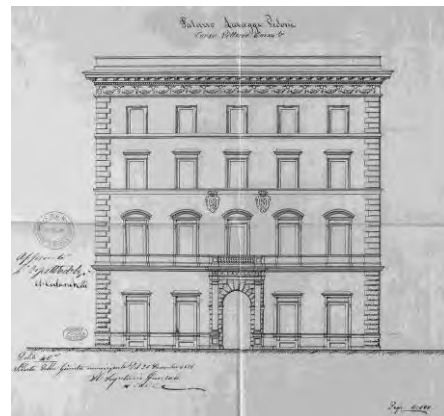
palazzo Lavaggi prospetto su corso Vittorio Emanuele
